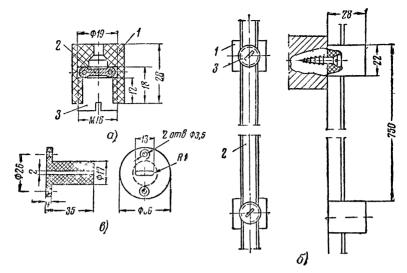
Конструкция изоляторов для ленточного кабеля КАТВ. a — изолятор для крепления кабеля к стене (1 — корпус, 2 — кабель, 3 — пробка); b — установка кабеля на стене b — втулка для прохода кабеля через оконную рамиу.
